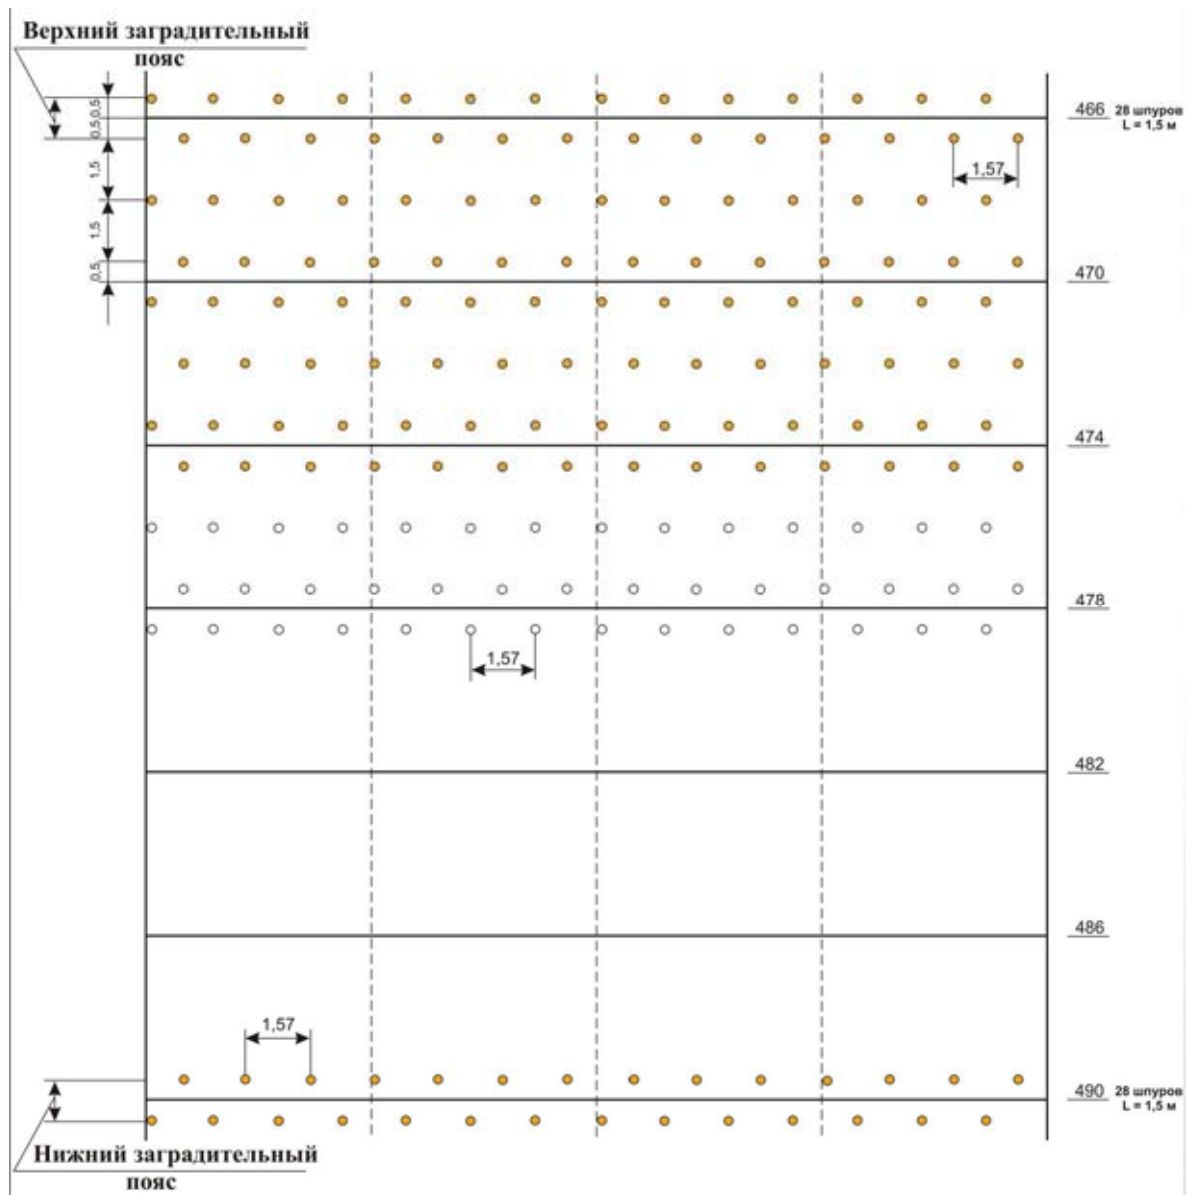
Схема выполнения работ по водоизоляции бетонной крепи в скиповом стволе шахты «Красноармейская-Западная № 1»
